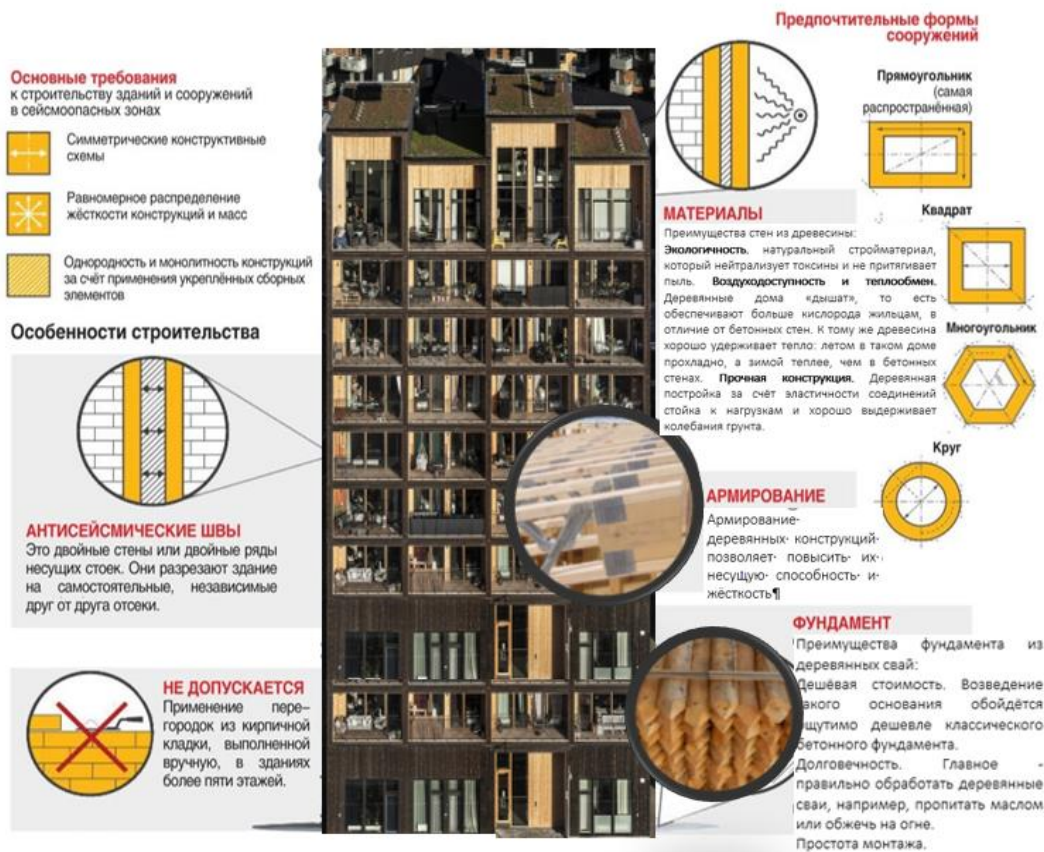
Схематичное отображение предпочтительных форм сооружений, применяемых конструкций, армирования, материалов, устройства антисейсмических швов и основных требований для проектирования и возведения сейсмостойких многоэтажных жилых домов
